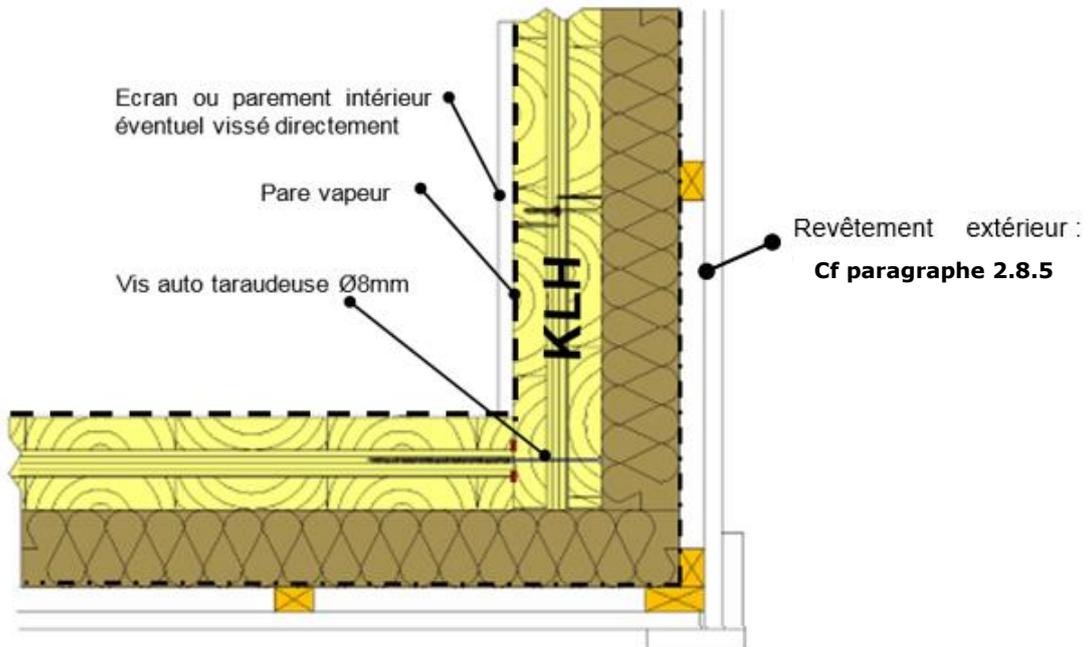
Coupe horizontale sur angle de murs extérieurs
